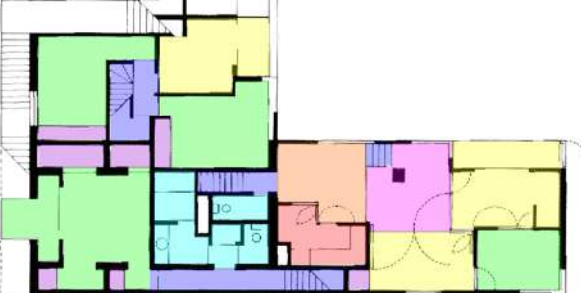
Fragmento da Planta do 1º Pav. E: 1/200
